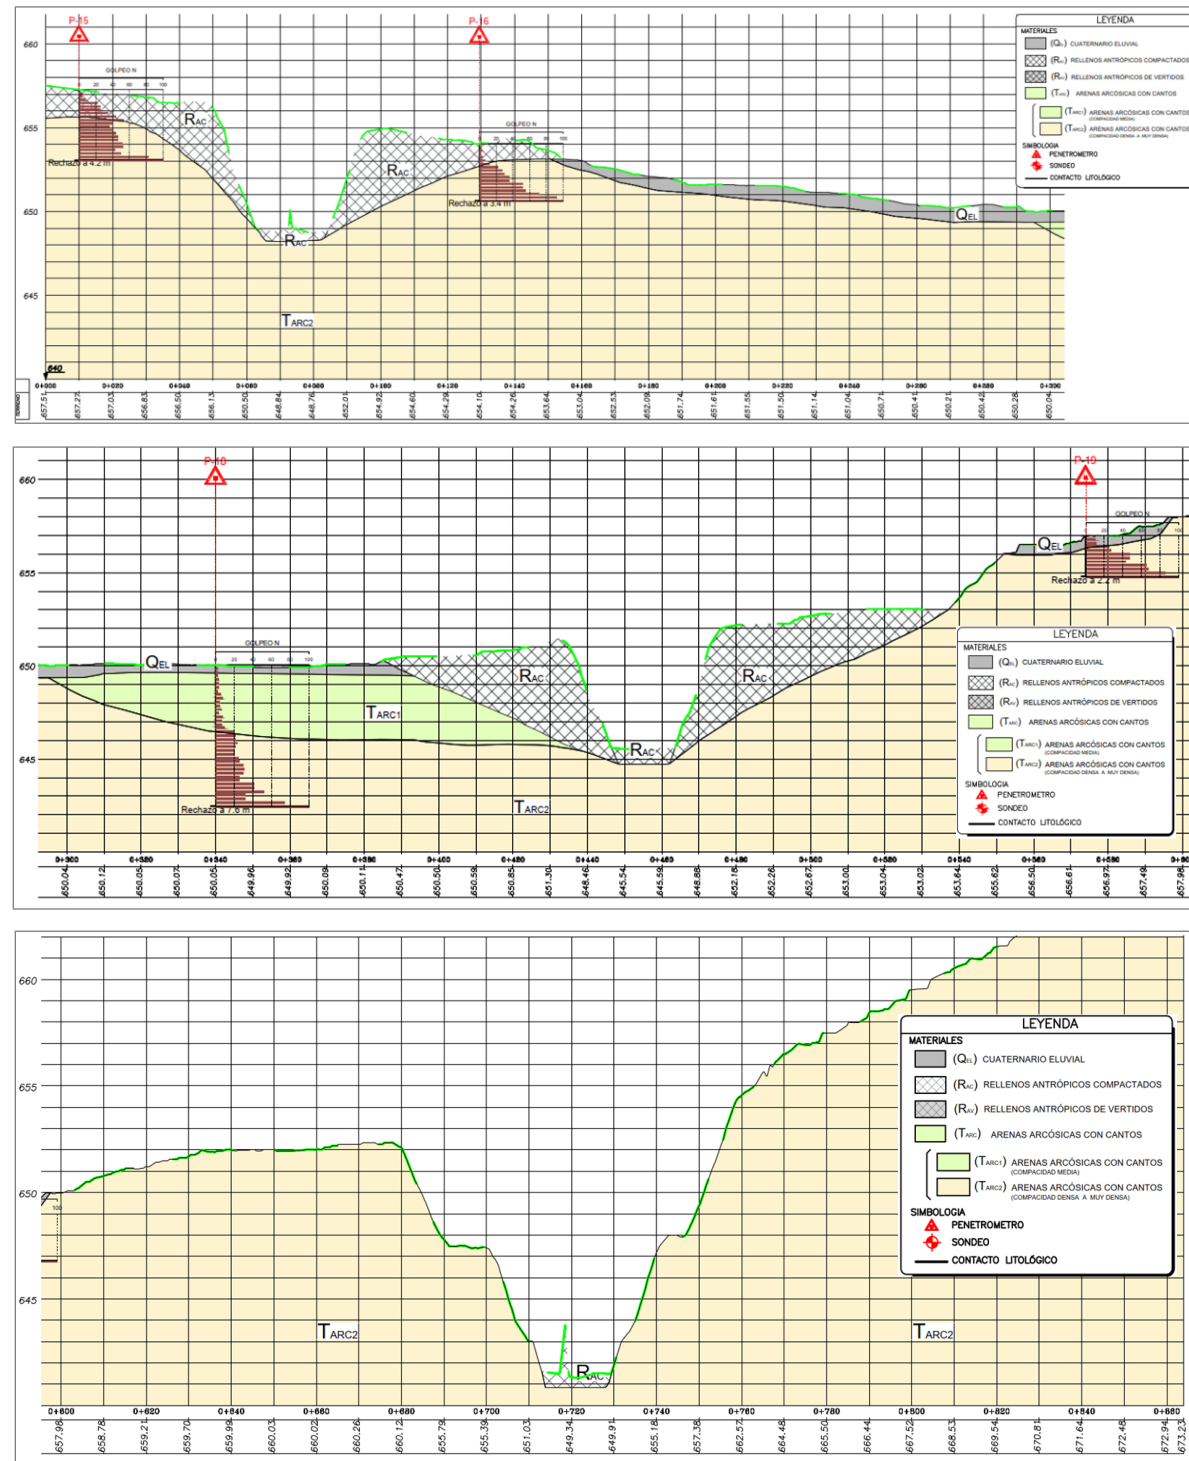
Perfil longitudinal Pantalla A1-16-MD-1(2)
